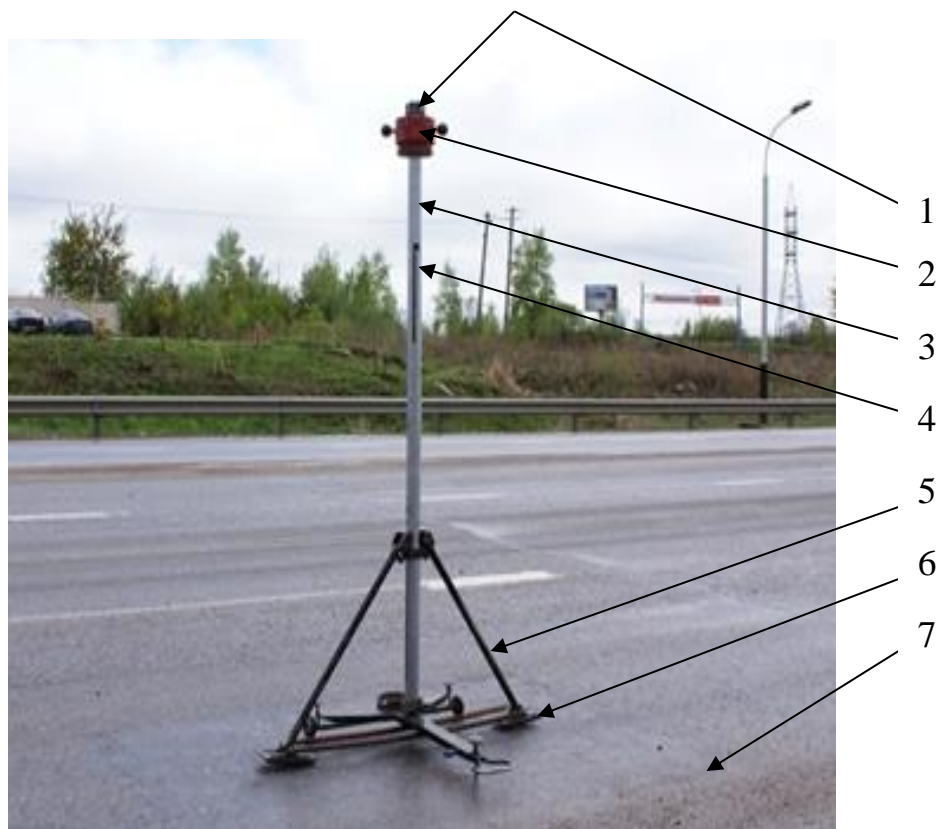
Портативный прибор ППК-Ф для определения коэффициента сцепления колеса автомобиля с дорожным покрытием
